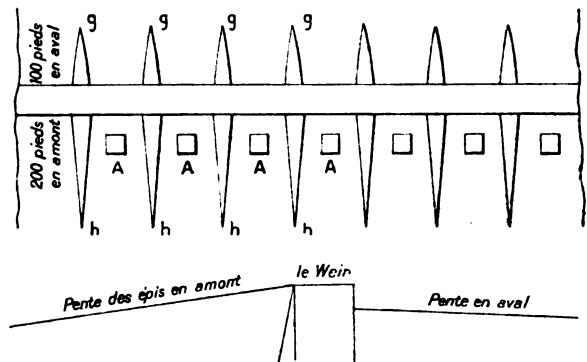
Plan et coupe d'un barrage permanent avec puits de fondation. — B, barrage; g, h, épis; A, puits de béton de 8 à 10 pieds de côté, 20 pieds de profondeur. Ces puits empêchent le travail du sable au pied du weir (barrage) et sous le weir.
